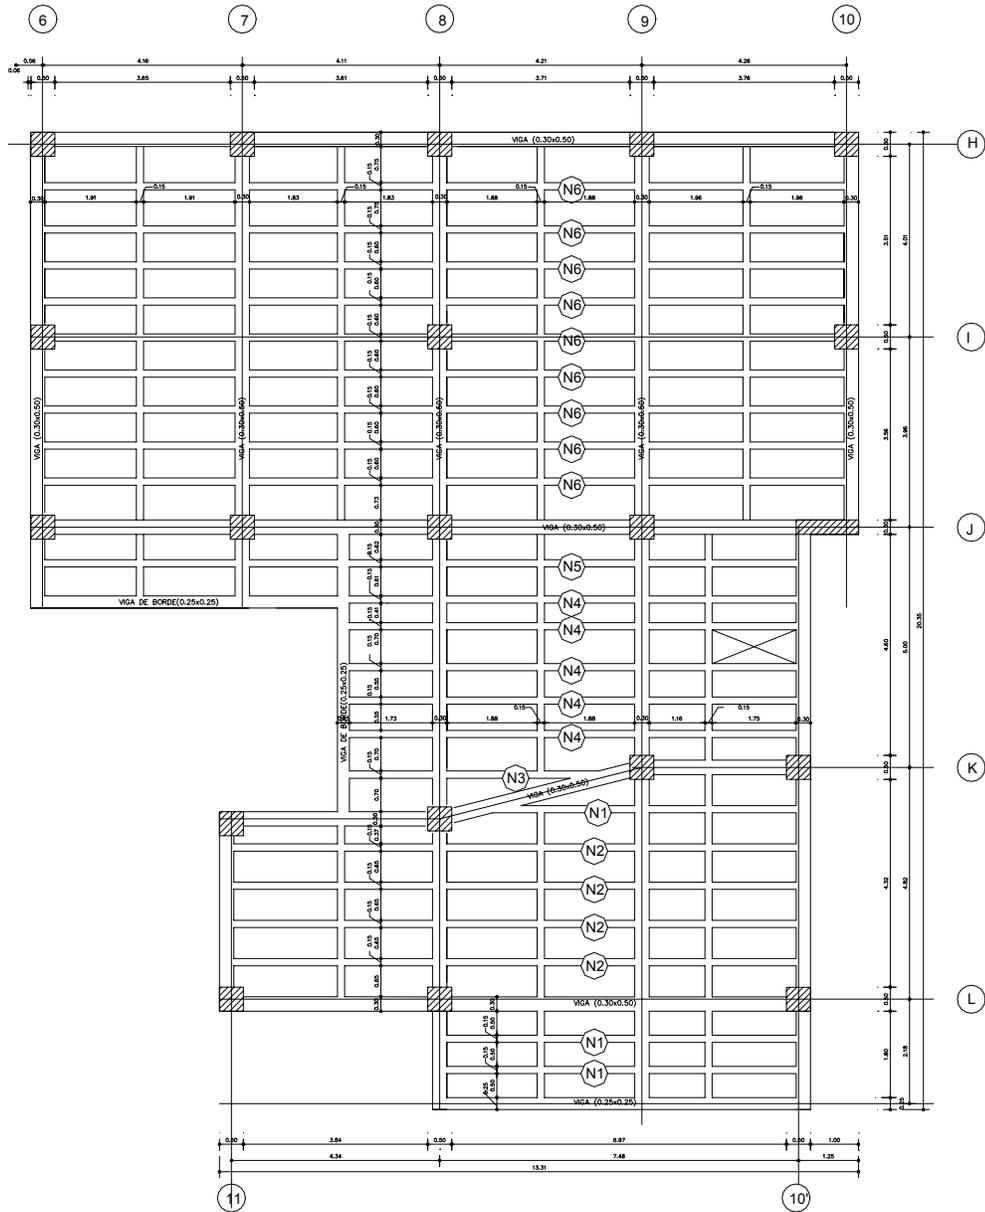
Planta estructural tercero, cuarto y quinto piso bloque 2
